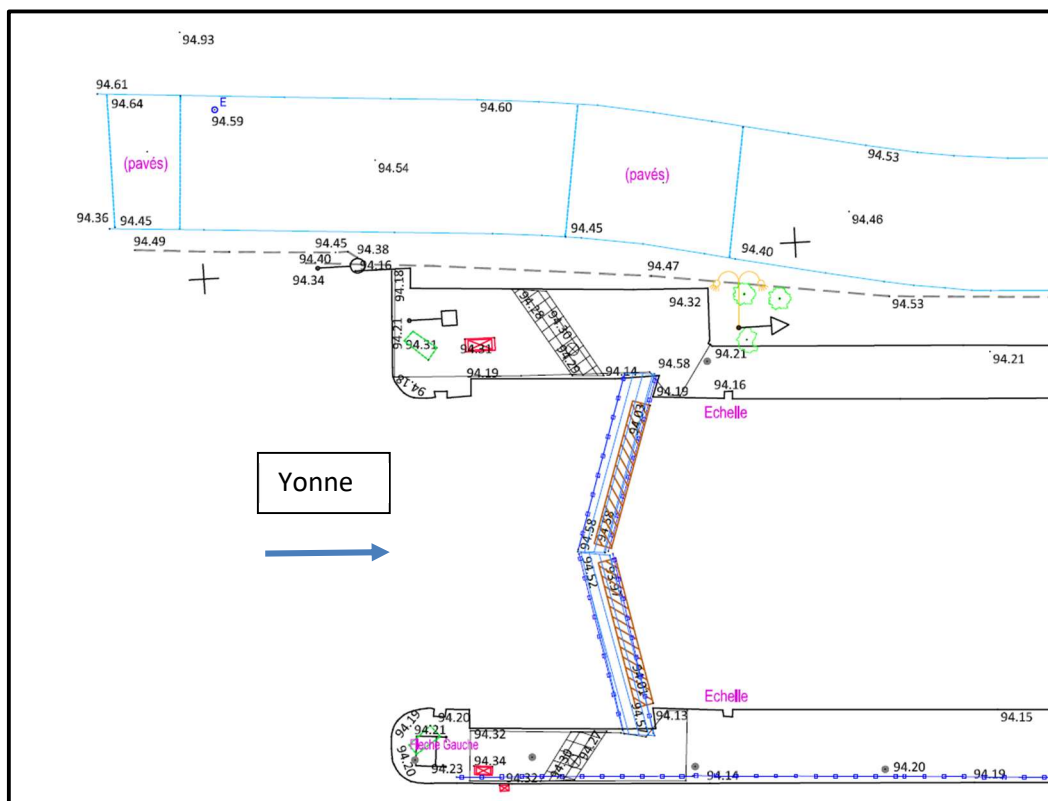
Vue en plan de la tête amont (Source : plan topo dressé par GEOESAT)
